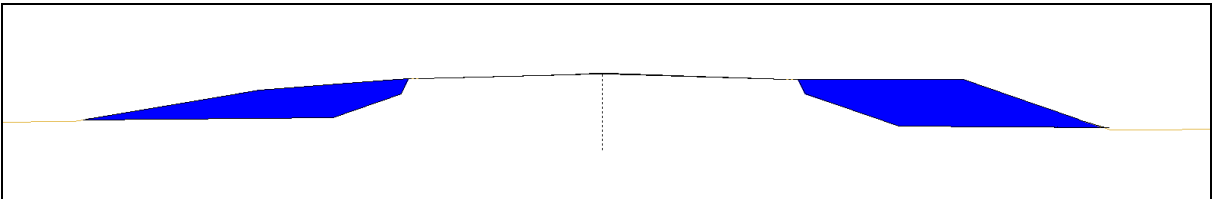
Excavación lateral del terraplén bajo las banquetas en tierra existentes
